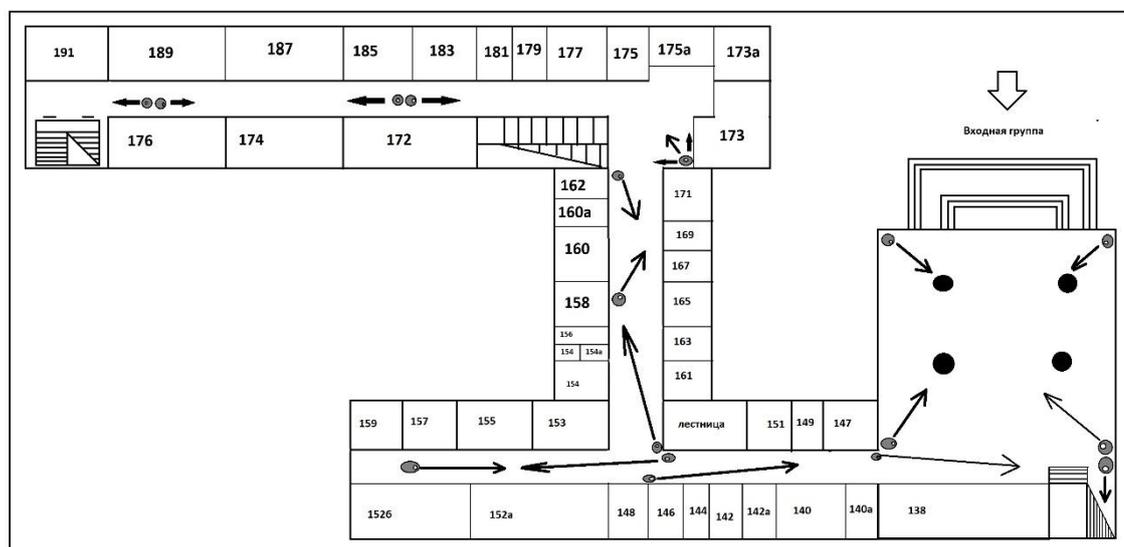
Спроектированный план здания ГМК КазНИТУ – 1 этаж
